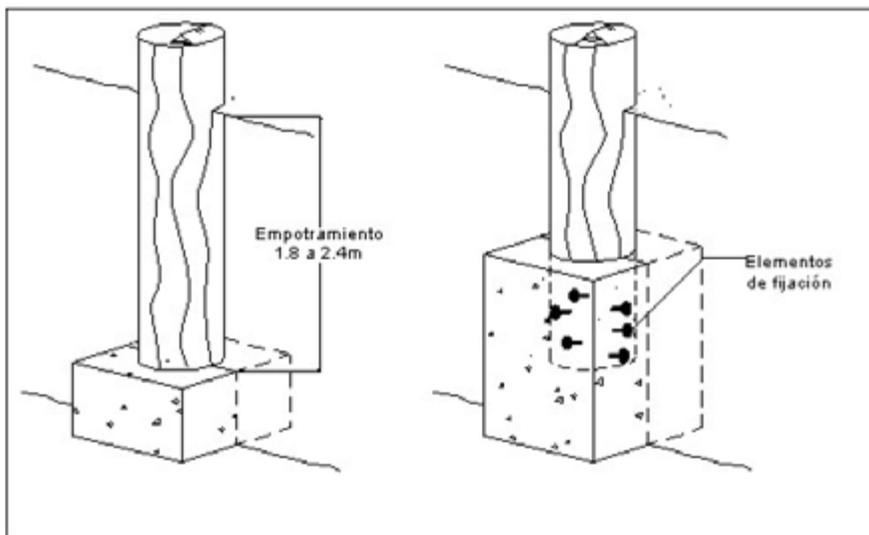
ALTERNATIVAS DE ANCLAJES EN LOSAS DE CIMENTACIÓN O CIMENTOS CORRIDOS
